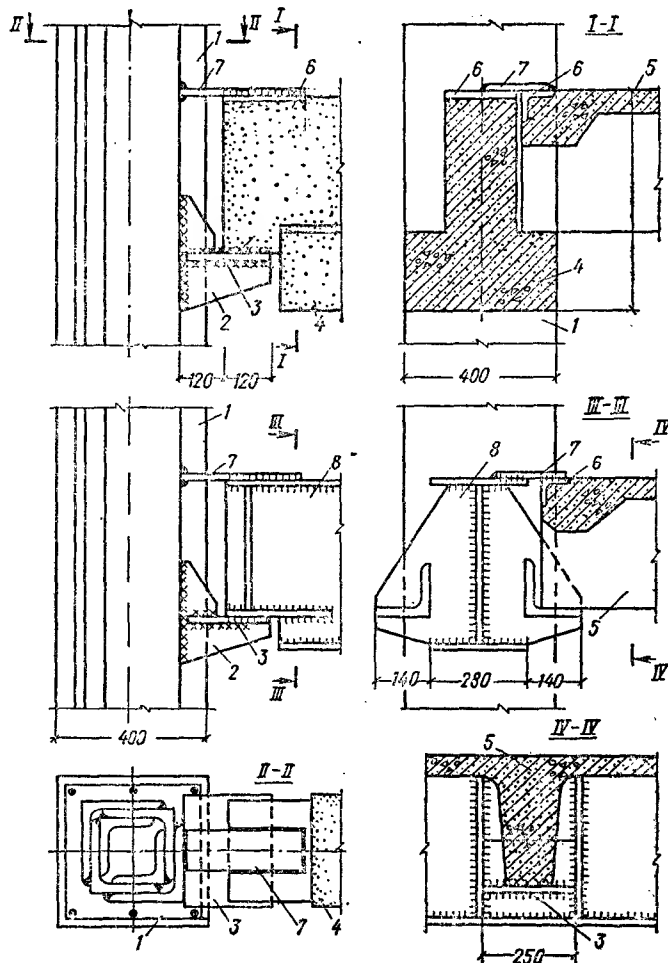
Железобетонный и стальной ригели длиной 9 м и их крепление к жесткой арматуре колонны
